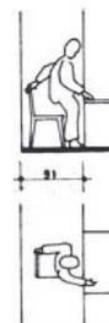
Ruang Gerak Minimum Dalam Jangkauan Ruang Baca
